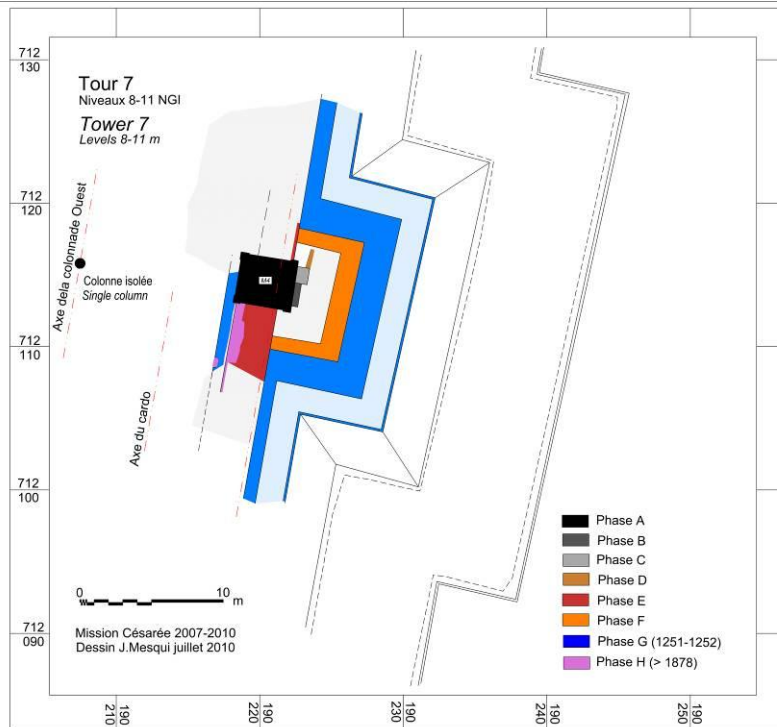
Plan de la tour T7 entre 8 et 11 m ASL
